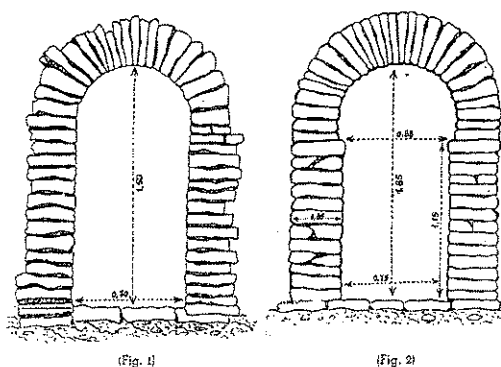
Sección de las cloacas descubiertas en la Plaza de Santa María (Trapero Pardo 1960).
